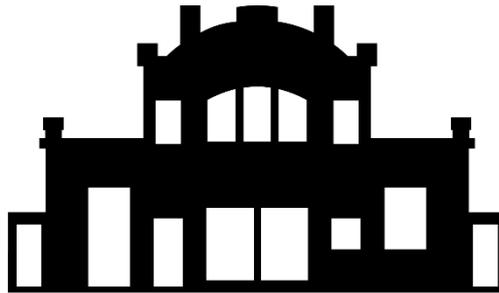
Indicação de cheios e vazios fachada Cinema Apolo.
